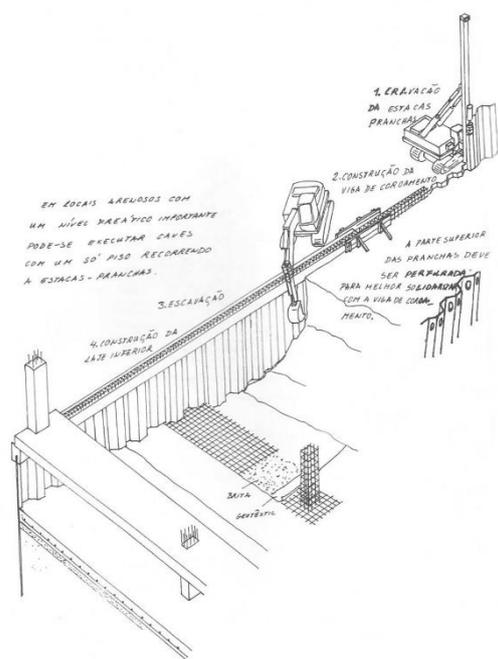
Desenho a descrever o uso pranchas metálicas para baixar o nível freático e construir a primeira laje.
